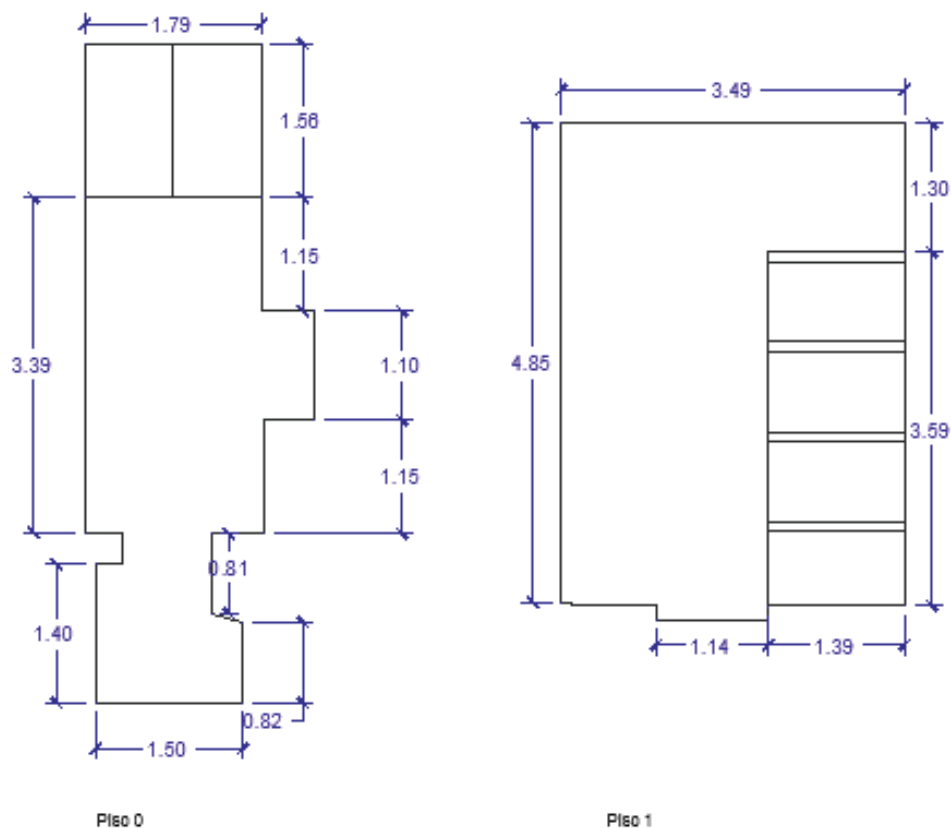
Levantamento, instalações sanitárias do Centro Artístico Albicastrense.
